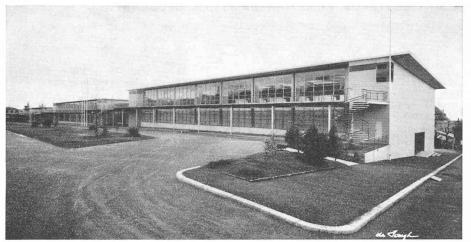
Pavillons sud. Façade sur la place de Beaulieu.
